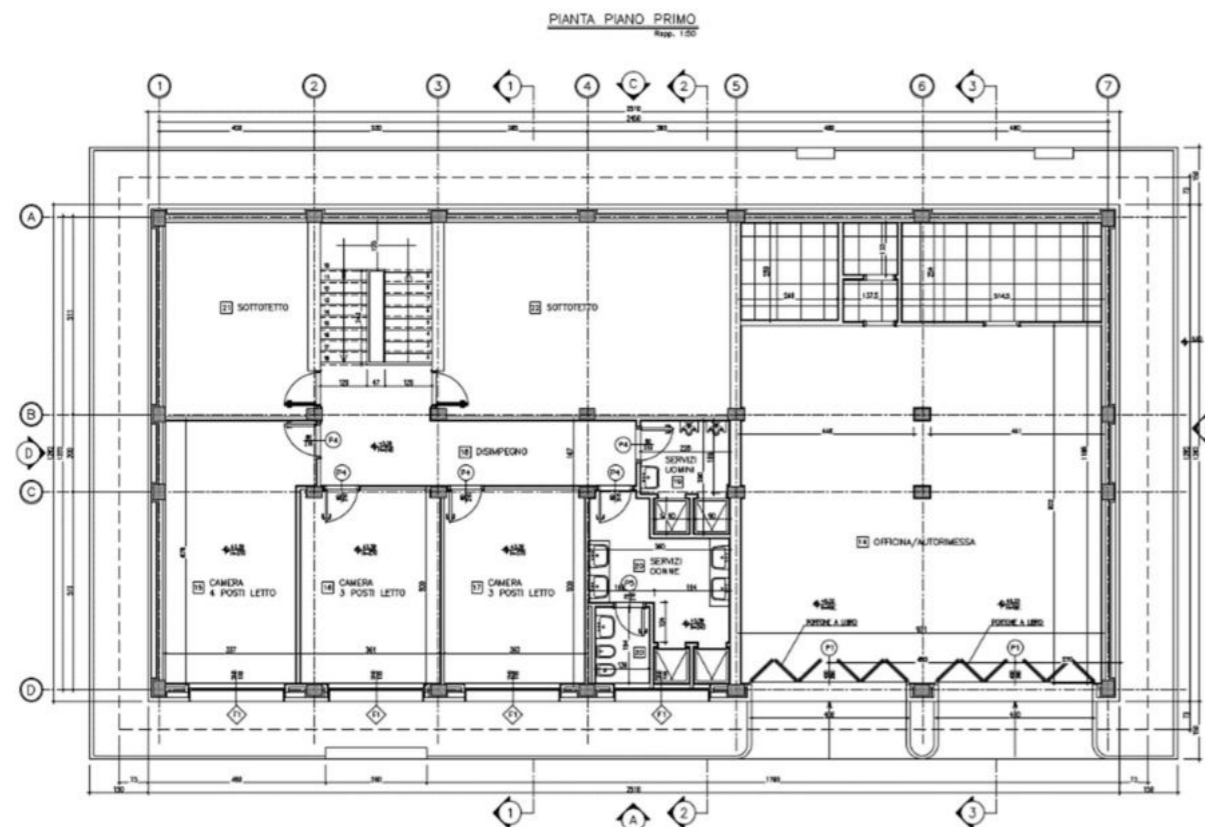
Fabbricato posto neve - Pianta e prospetti
